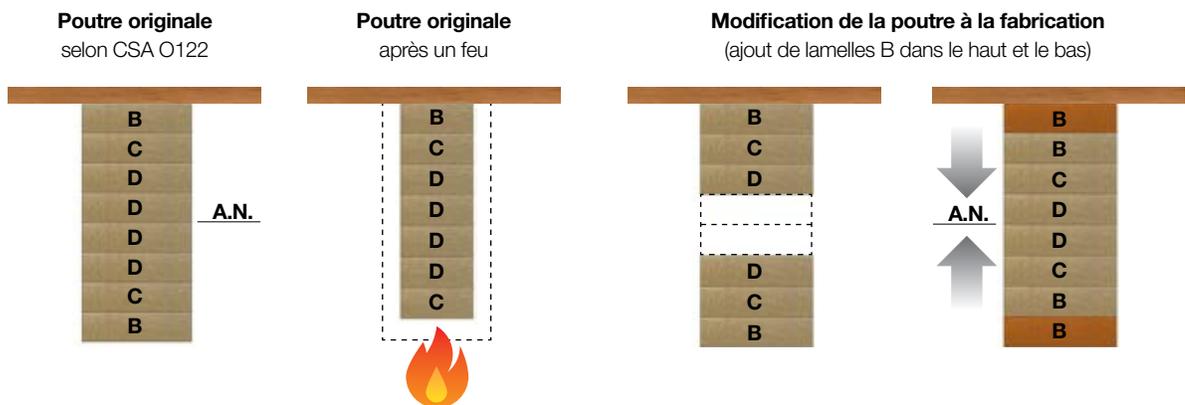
• Exemple de modification de poutre pour un DRF requis de 60 minutes
